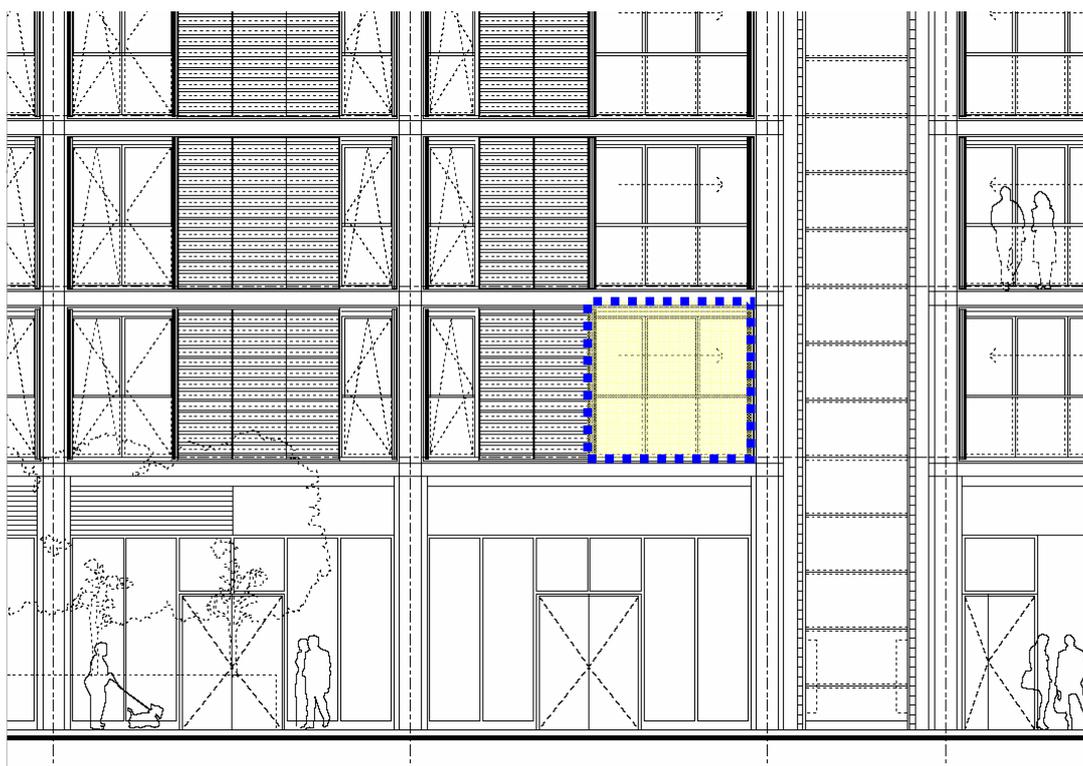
Indicazione in prospetto della facciata oggetto di valutazione
